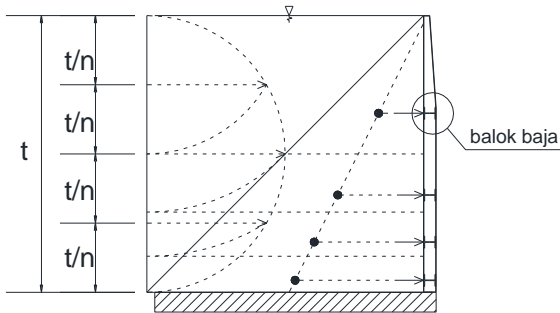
Profil Balok Baja pada Pintu Air Bendung
